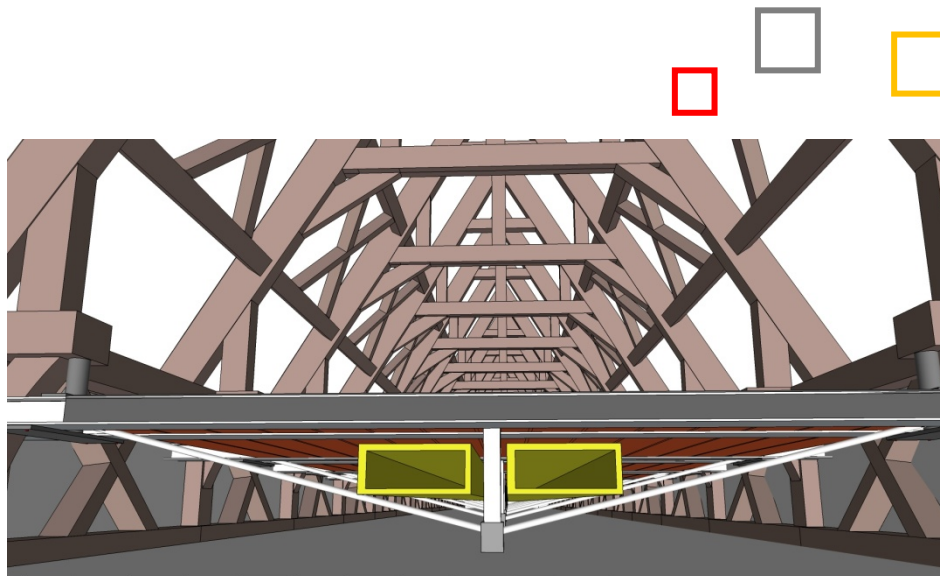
Gains de ventilation glissées entre les tirants et les poutres du plancher.
